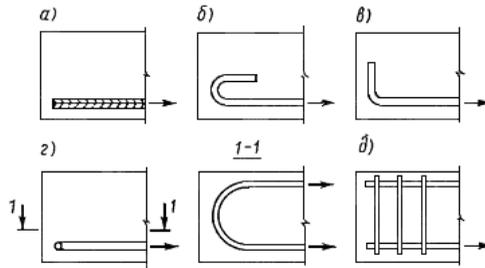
Фрагмент анкеровки рабочей арматуры в бетоне элемента
